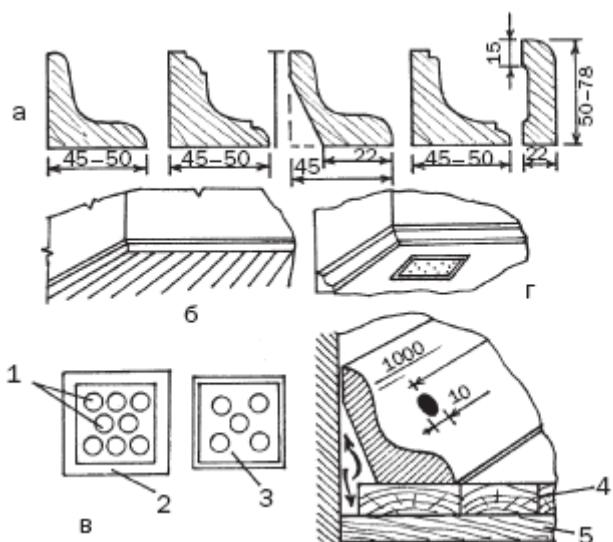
Установка плинтусов и вентиляционных решеток: а – профили плинтусов; б – установленный плинтус; в – рамка; г – установка решетки; д – плинтус с нащельником; 1 – отверстия; 2 – рамка; 3 – решетка; 4 – пол; 5 – балка
